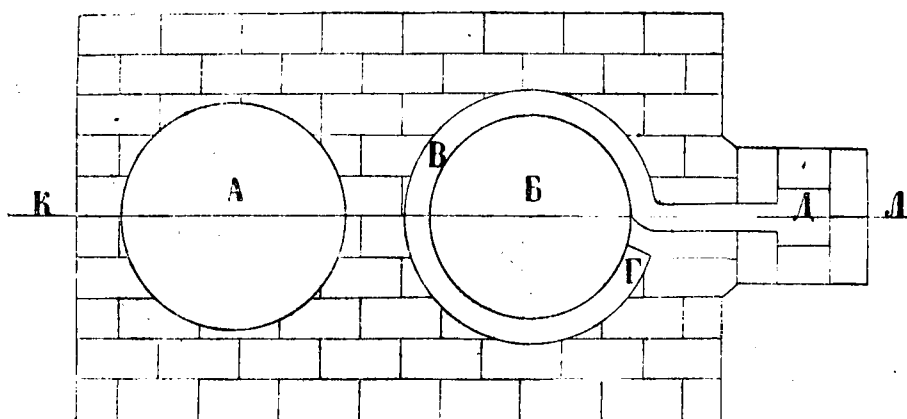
Устройство котловъ для обварки овощей (планъ).
